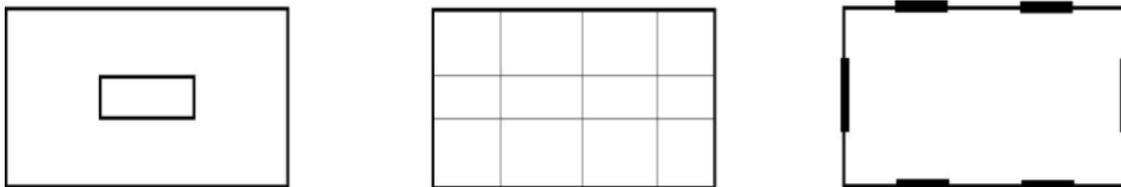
formas de disposición de los muros en planta con buena rigidez torsional
